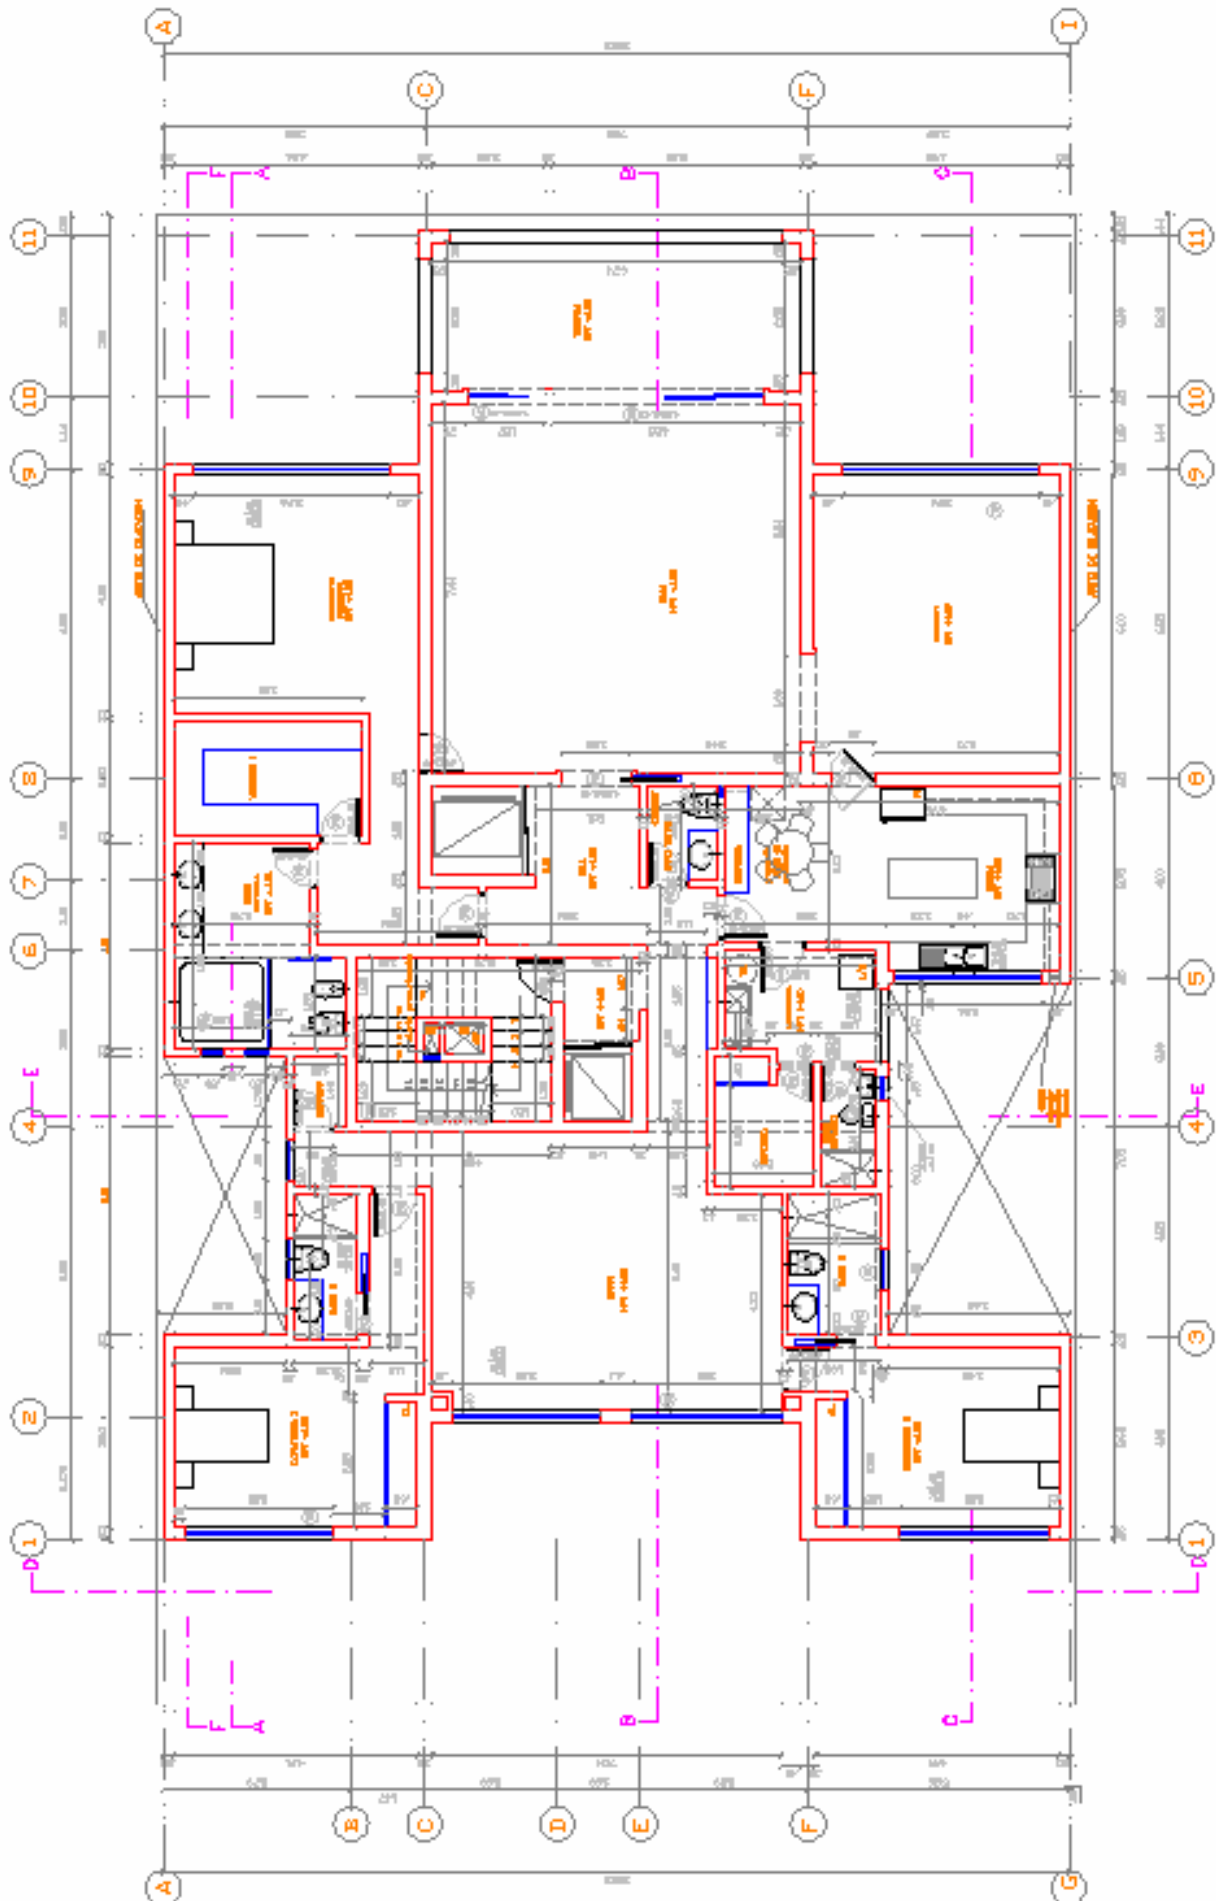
Vista en Planta Piso Típico (2do al 5to)
